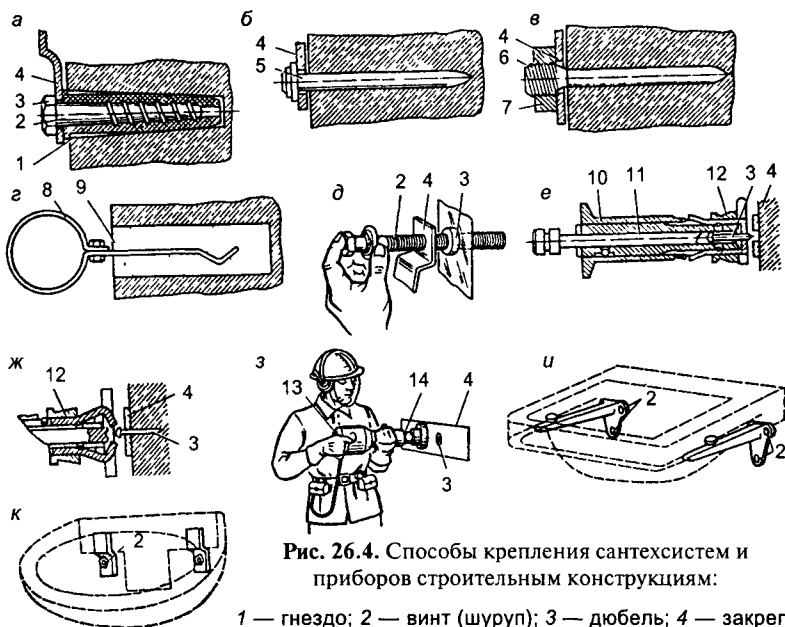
Способы крепления сантехсистем и приборов строительным конструкциям:
